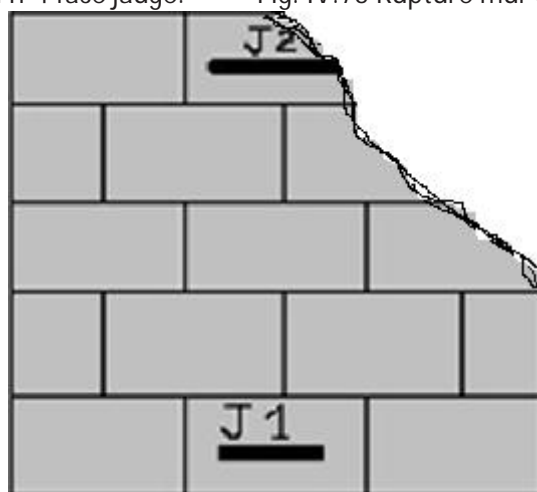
Rupture mur 8 trous de l'essai n°4.
